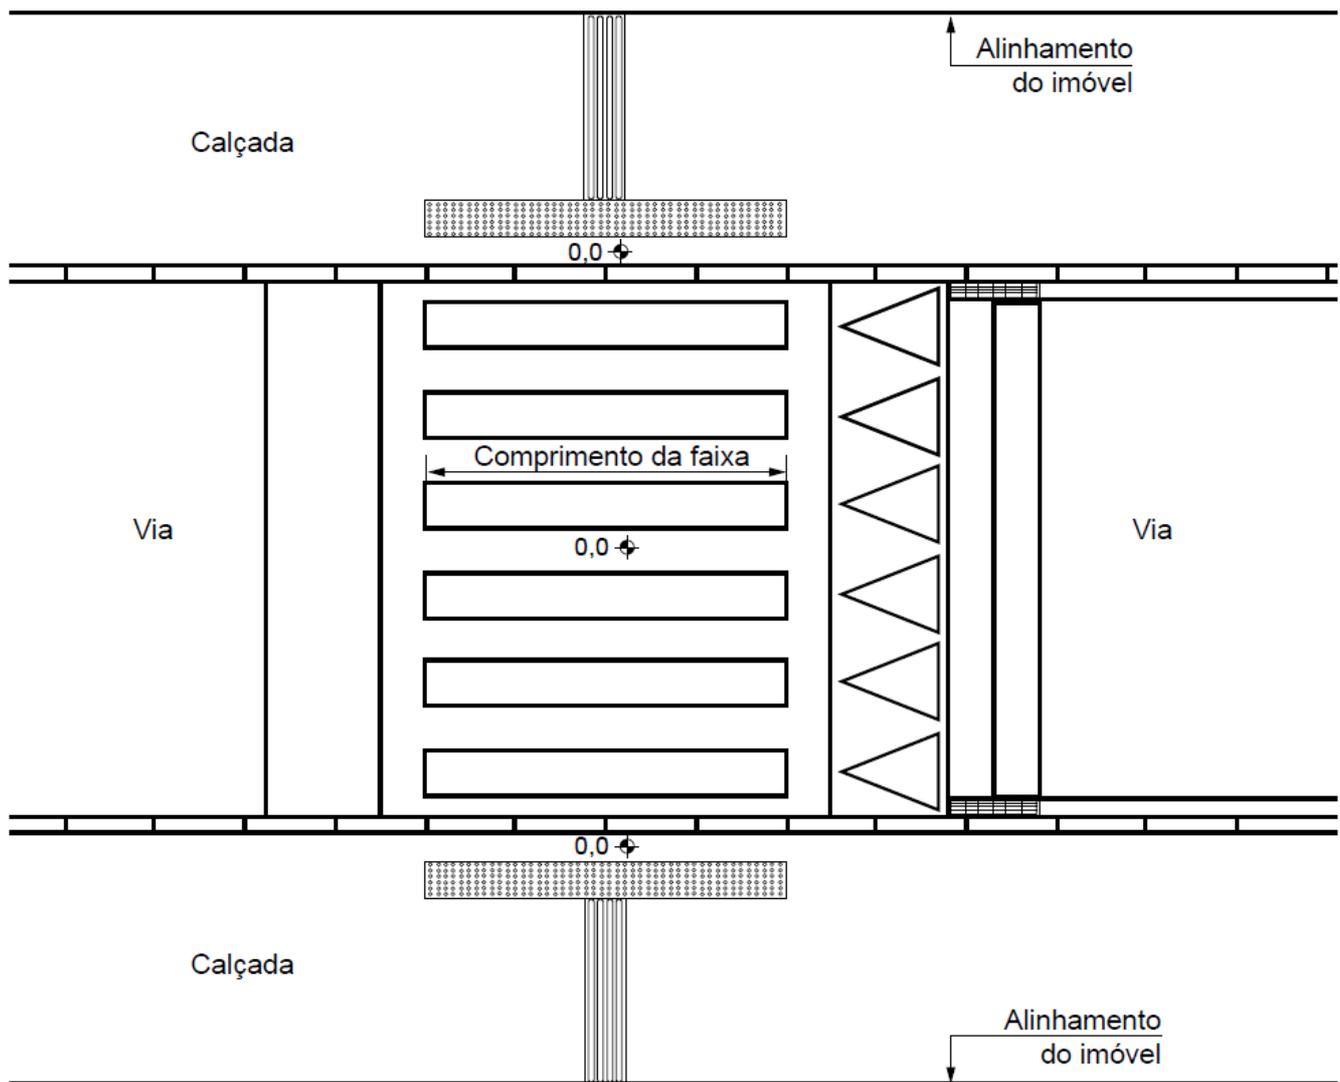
Faixa elevada para travessia – Exemplo – Vista superior
